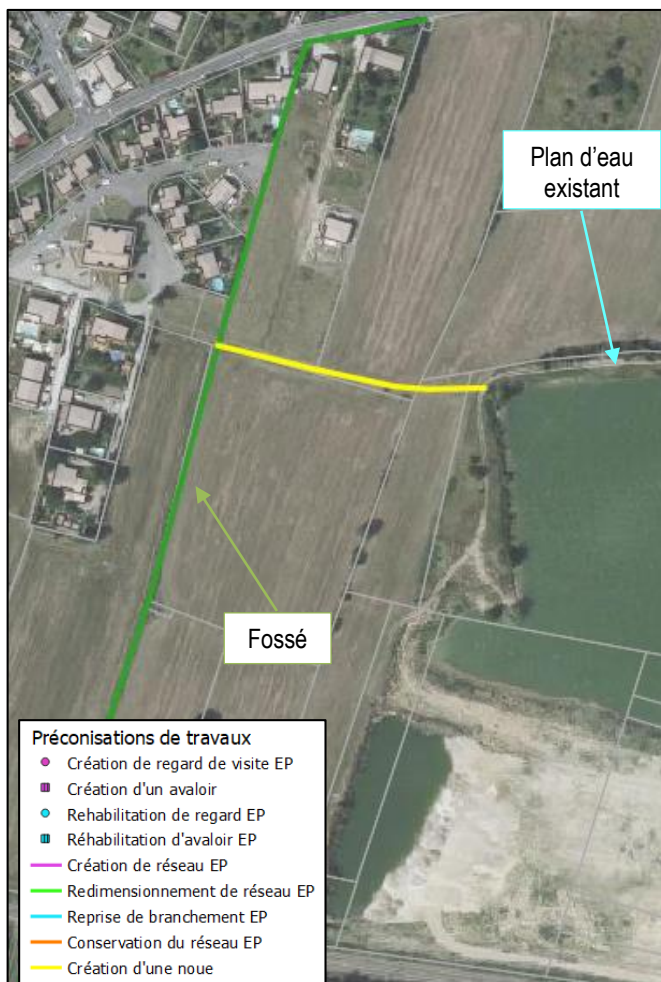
Action 4.3 - Raccordement plan d'eau existant
